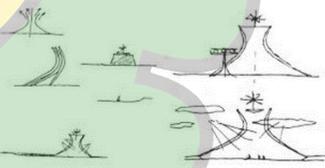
23 Denah dan Tampak Katedral Brasilia
